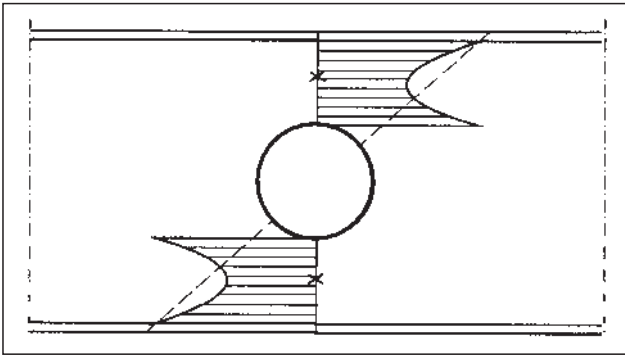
Lokale Bezugsspannungen an einem geschweißten I-Profil mit Stegaussparung
